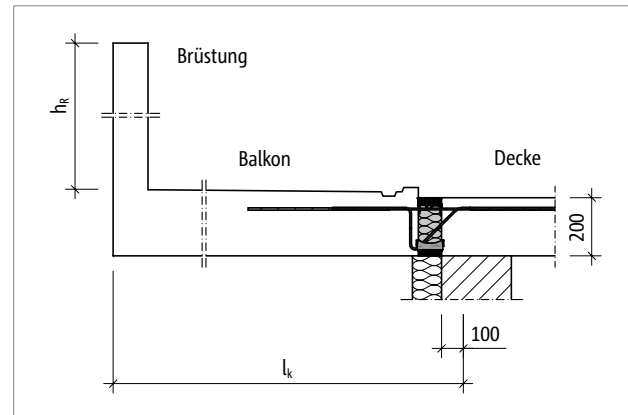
Schöck Isokorb® T Typ KL: Statisches System
